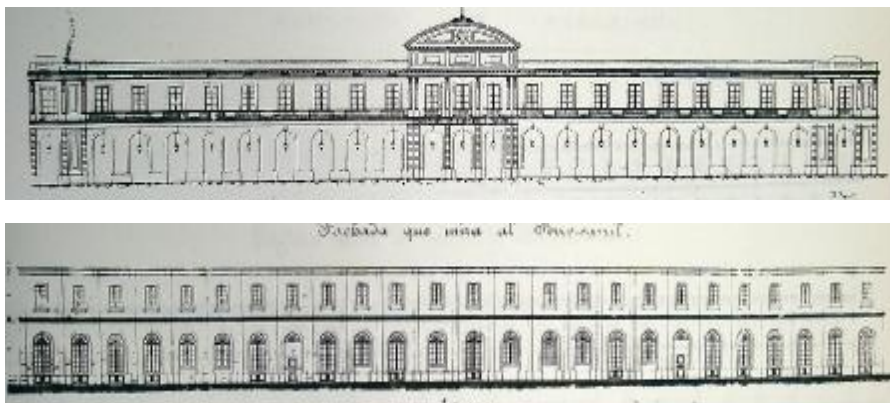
y 264.- Fachada principal y recayente a las vías.
